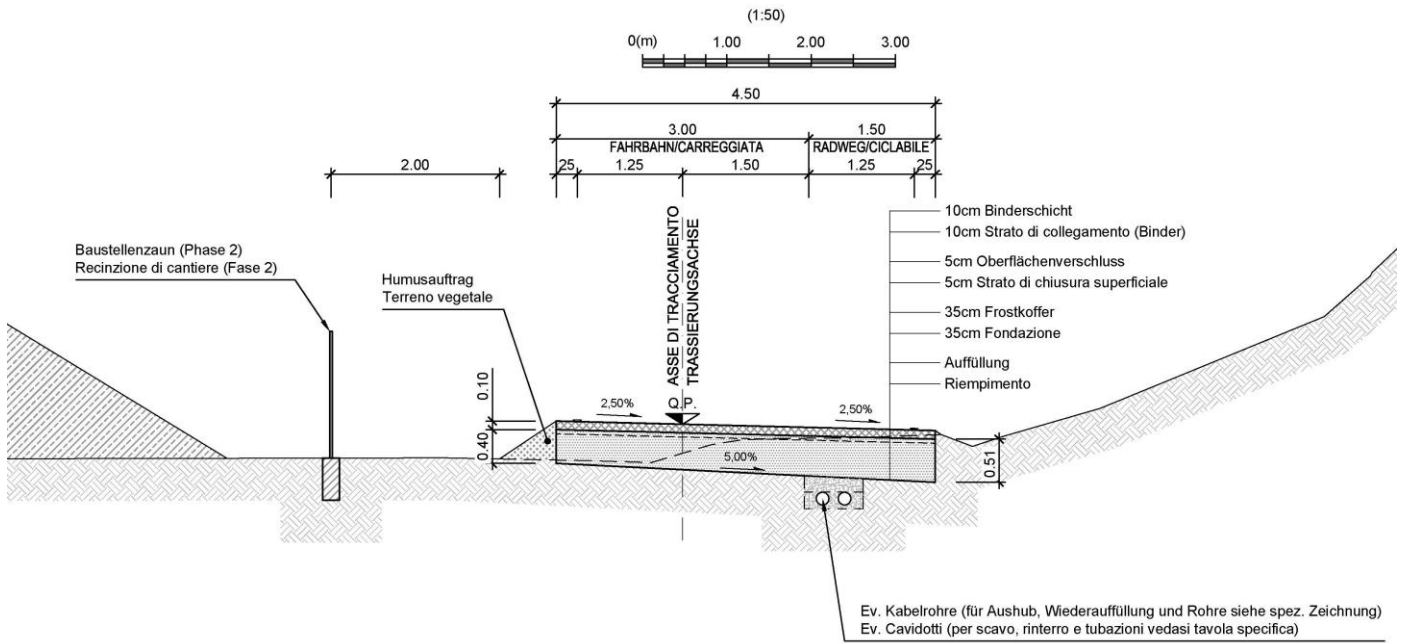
Regelquerschnitte Fahrradweg Baustelle Genauen 2 – Anfangsstrecke
